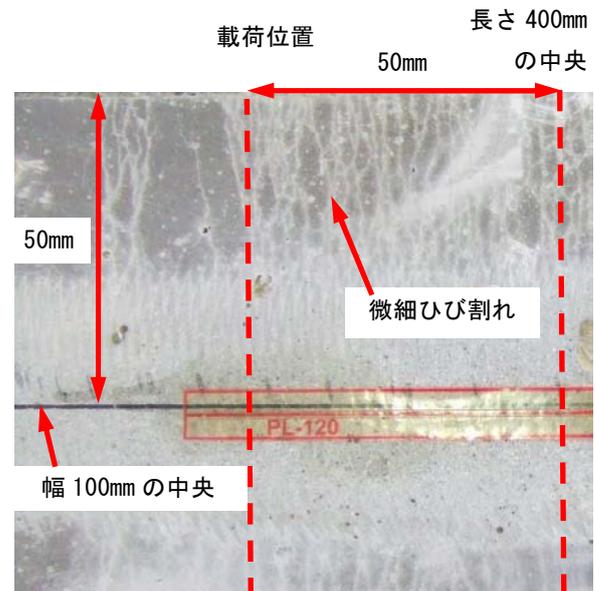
(c)に示す高じん性モルタルは、コンクリート補強用の太径ビニロン繊維を多量に使用したものである。この場合、ひび割れ本数は高じん性コンクリートよりも多くなりひび割れの分散性が高まるが、ひび割れ間隔は数cm程度となり、微細ひび割れと呼ぶ領域には至らない。設計においてひび割れ分散性をどこまで求めるかによるが、ひび割れ分散性を高めるためには、細径のビニロン繊維等を多量に使用する必要がある。その他、さまざまな材料・配合の工夫を行うことにより、写真-1(d)に示すように、約50mmの範囲（供試体の長さ方向400mmの中央から荷重位置までの範囲）に相当数のひび割れが発生し、かつ1本当たりのひび割れ幅も小さい、HPRCCに分類される複数微細ひび割れ型の高じん性モルタルを得ることができる。このように、微細なひび割れに分散させることにより、塩化物イオン等の劣化因子の侵入を抑制し、部材の長期供用を可能にできる。
